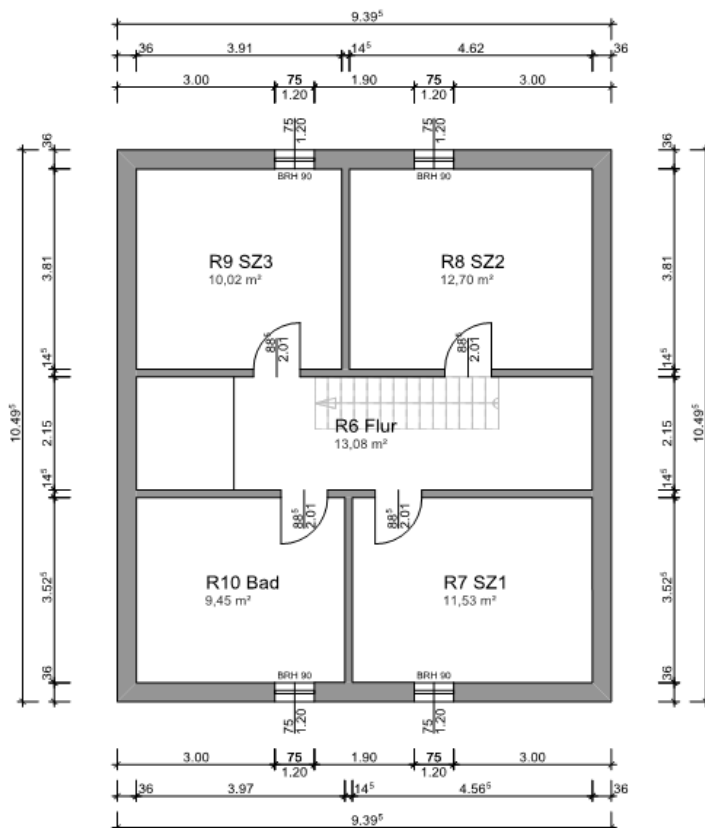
Grundriss OG, Einfamilienhaus
